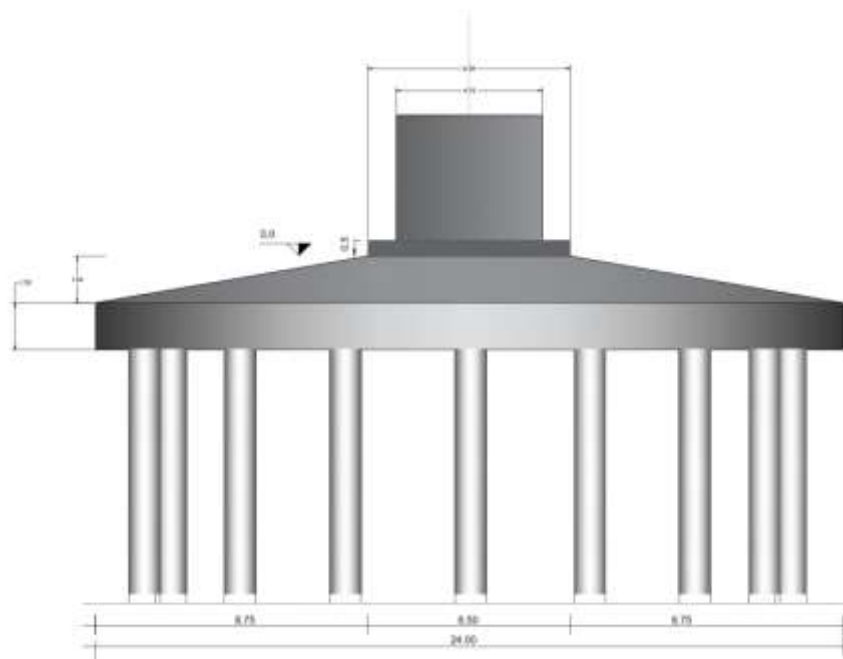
Schema geometrico di riferimento della struttura di fondazione
